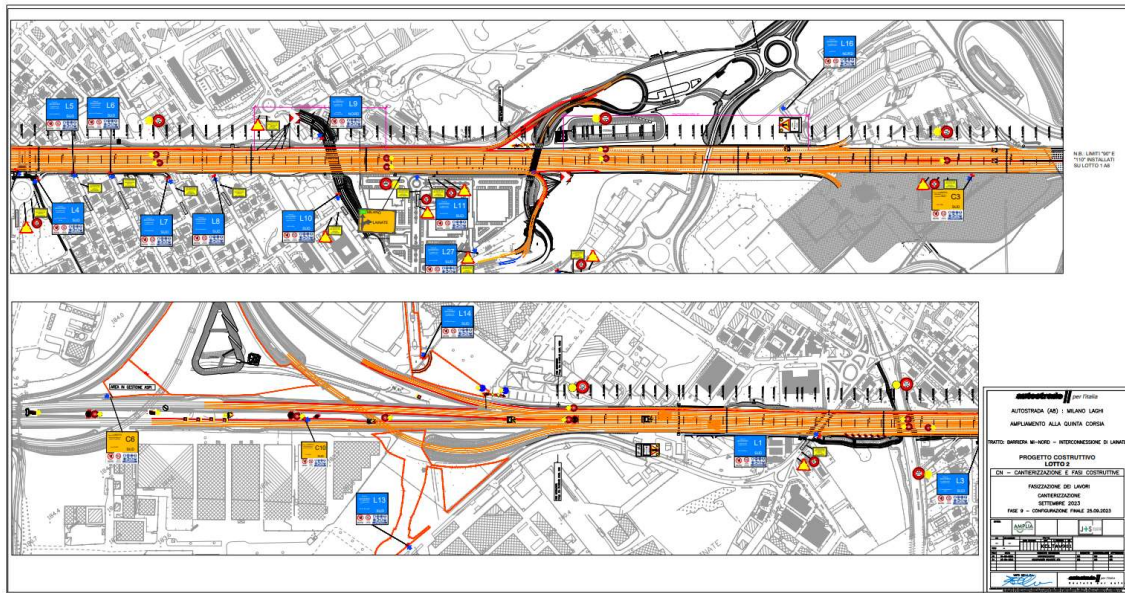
planimetria segnaletica per apertura provvisoria” (CN – cantierizzazione e fasi costruttive, fasizzazione dei lavori, settembre 2023)
